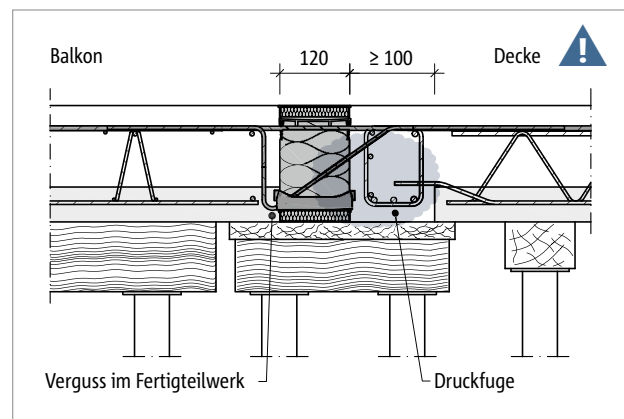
Schöck Isokorb® XT Typ KL: Indirekte Lagerung, Einbau in Verbindung mit Halffertigteilplatten (hier:  $h \leq 180$  mm), Druckfuge deckenseitig
